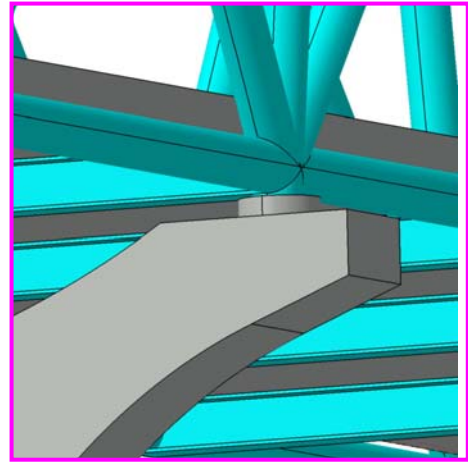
Detalle A del apoyo de la estructura de la base y de las vigas de sección en I bajo el tablero.
